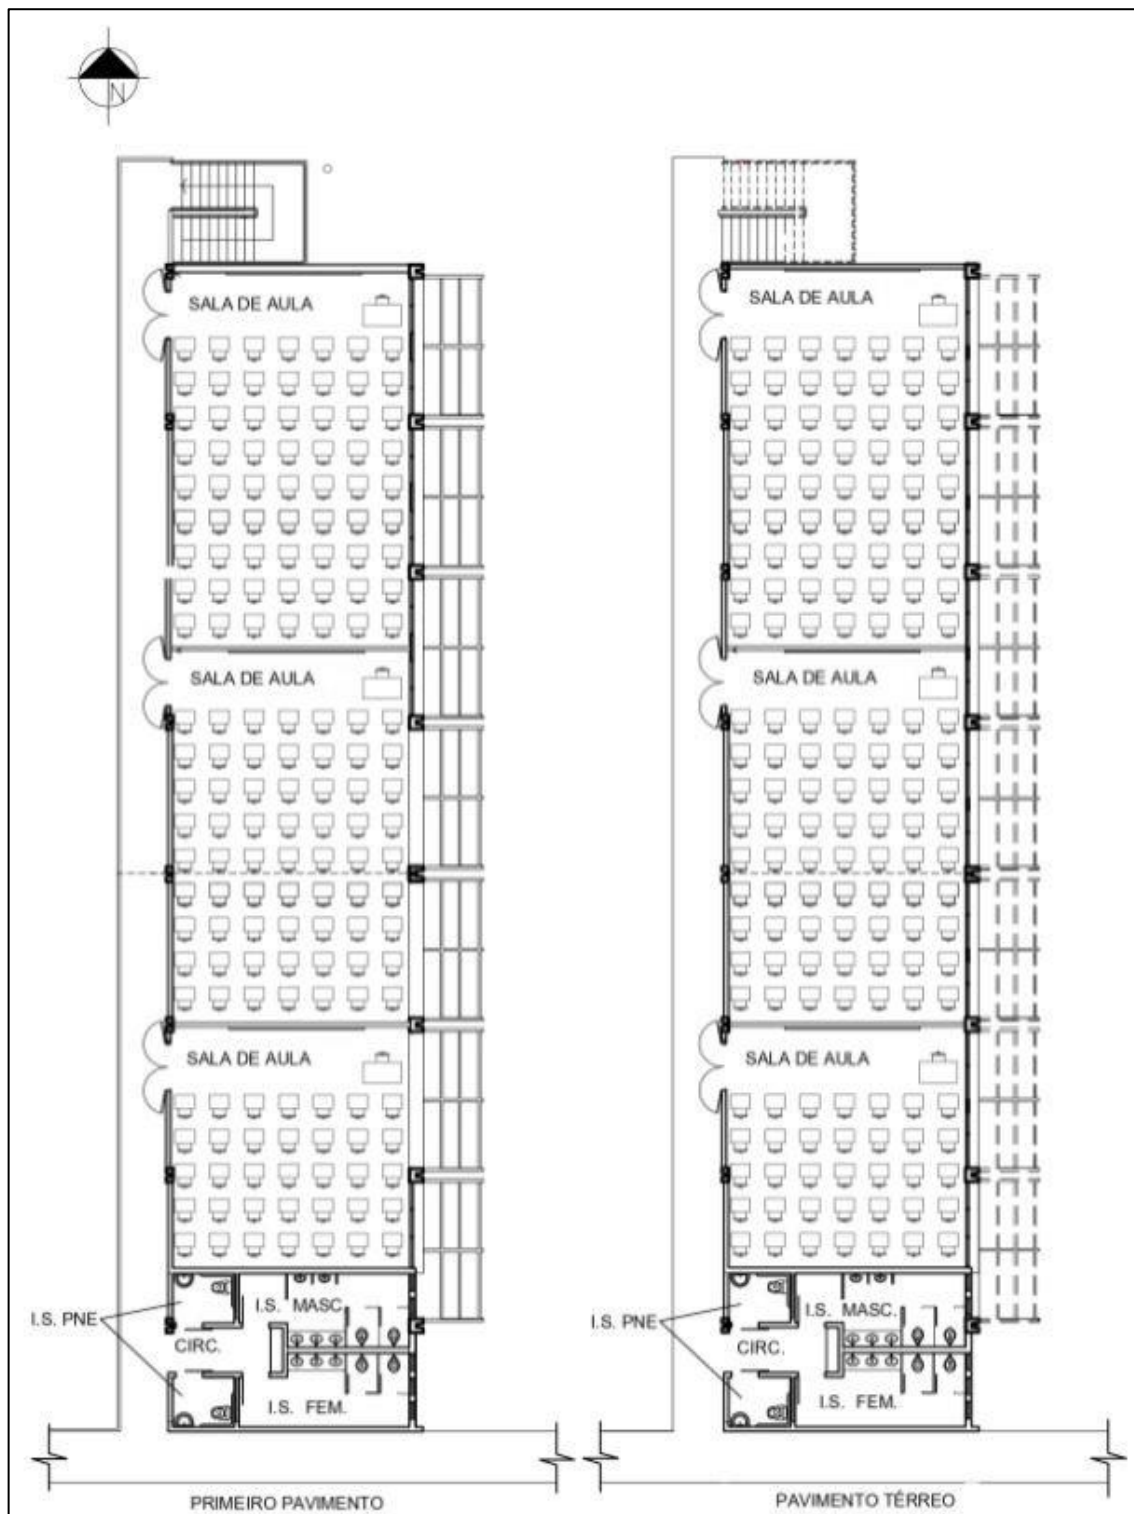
Plantas baixas dos dois pavimentos da edificação
